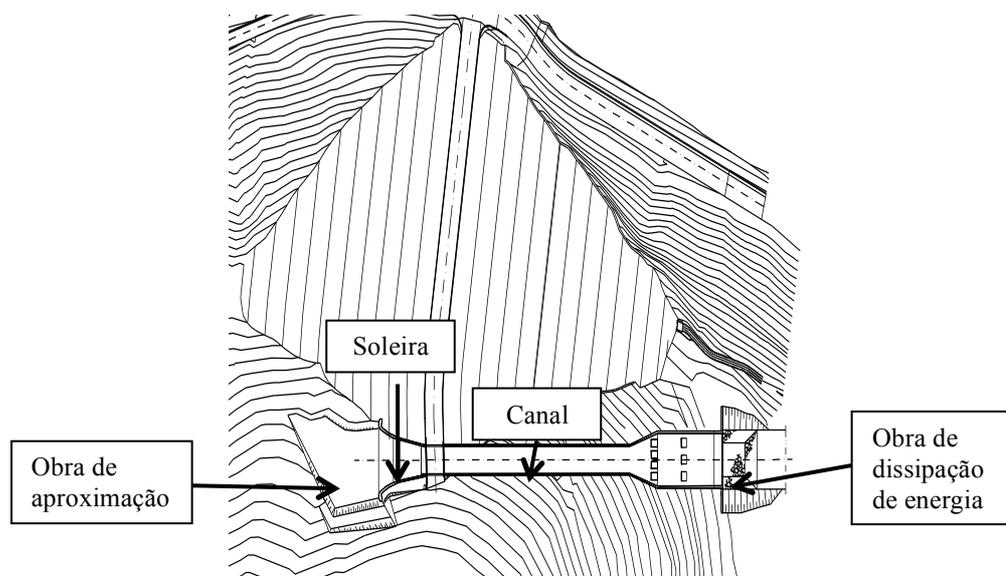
Planta esquemática de vertedouro em canal de encosta e bacia de dissipação de energia
